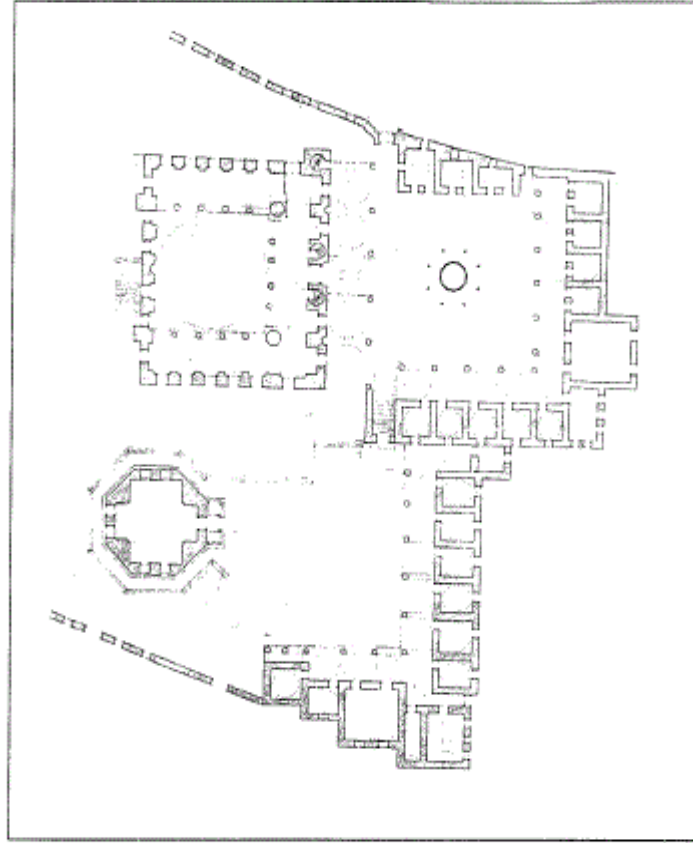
مسقط أفقي لمدرسة قايي اغاسي في اماسيا (عن : جابريل) .
